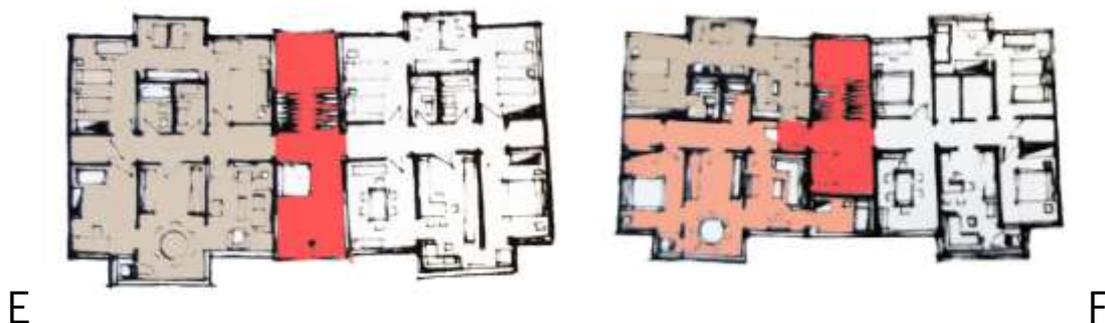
Planta “E”, proposta de organização espacial para uma família composta por 3/4 elementos. Planta “F”, proposta de organização espacial para um casal jovem e/ou um só elemento (adaptada de COELHO & CABRITA, 2003).
